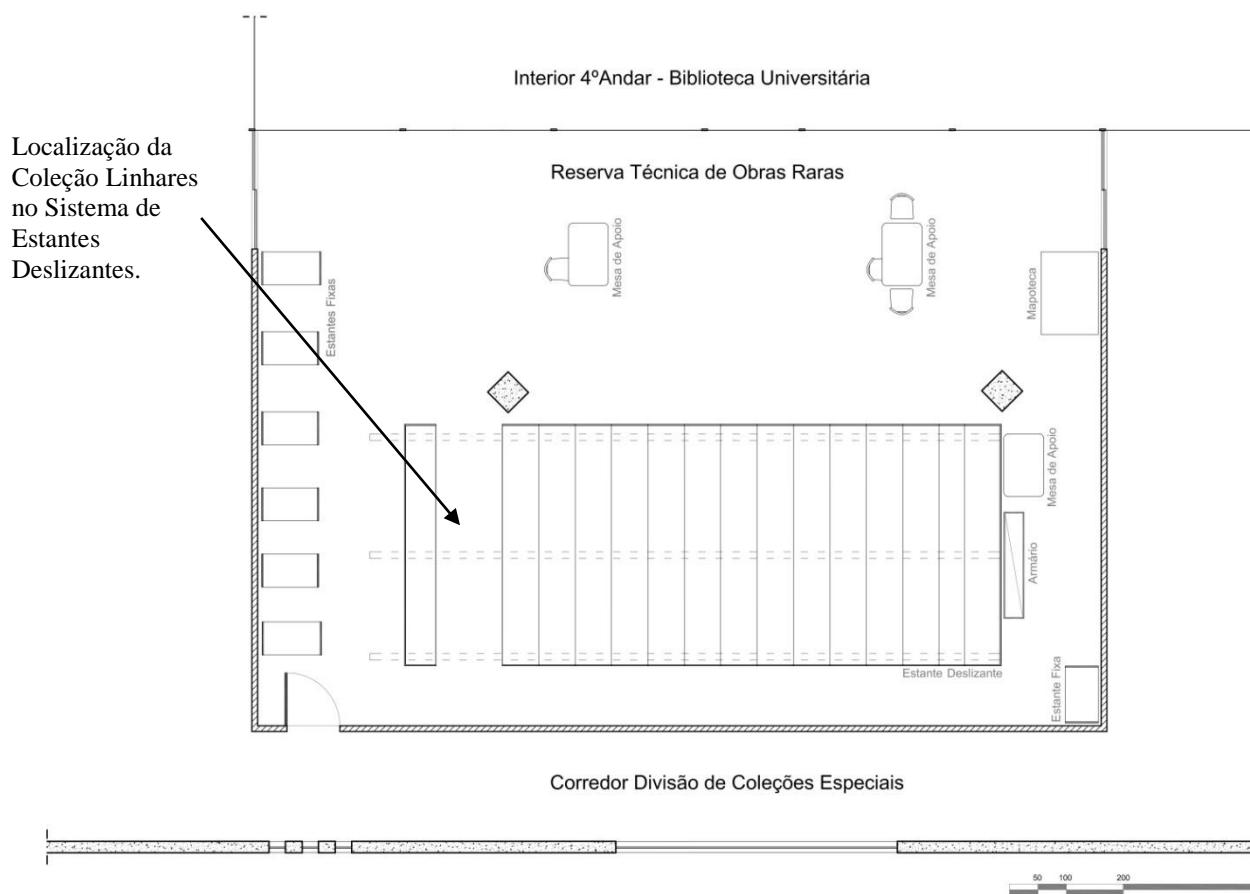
Planta baixa da Reserva Técnica de Obras Raras.
